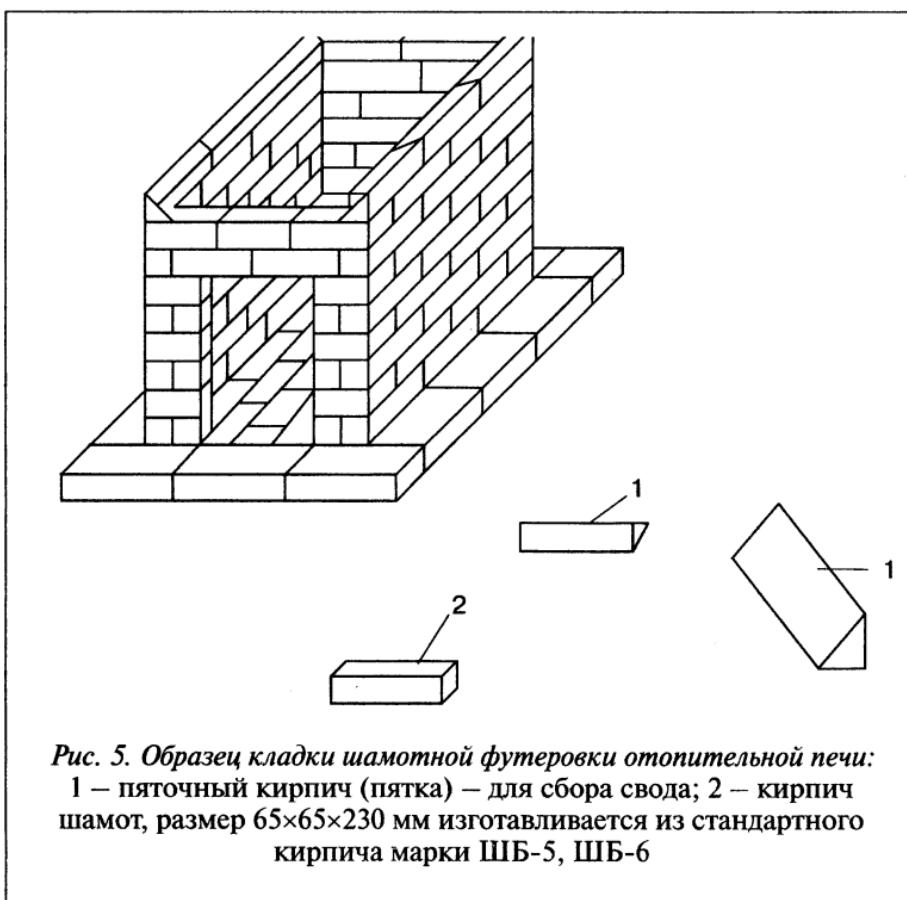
Образец кладки шамотной футеровки отопительной печи:
